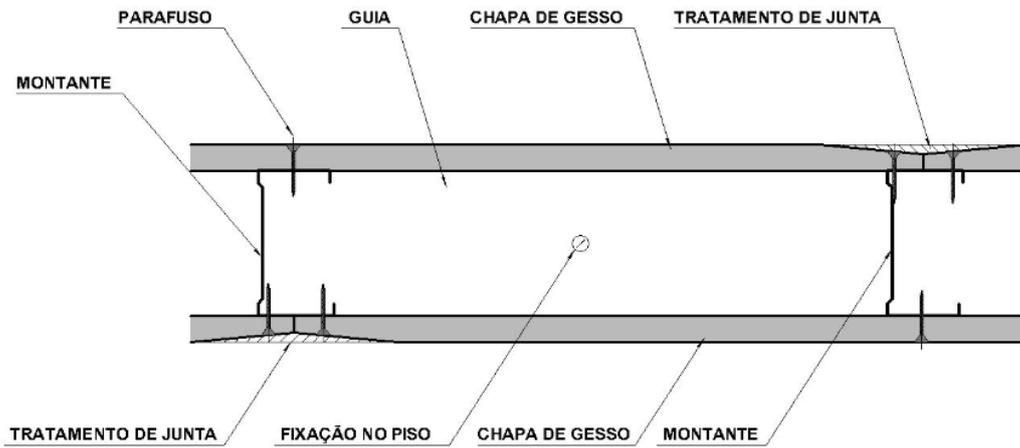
Detalhamento do sistema construtivo de vedação vertical em chapas de gesso para Drywall com estrutura simples/chapa simples – corte horizontal
